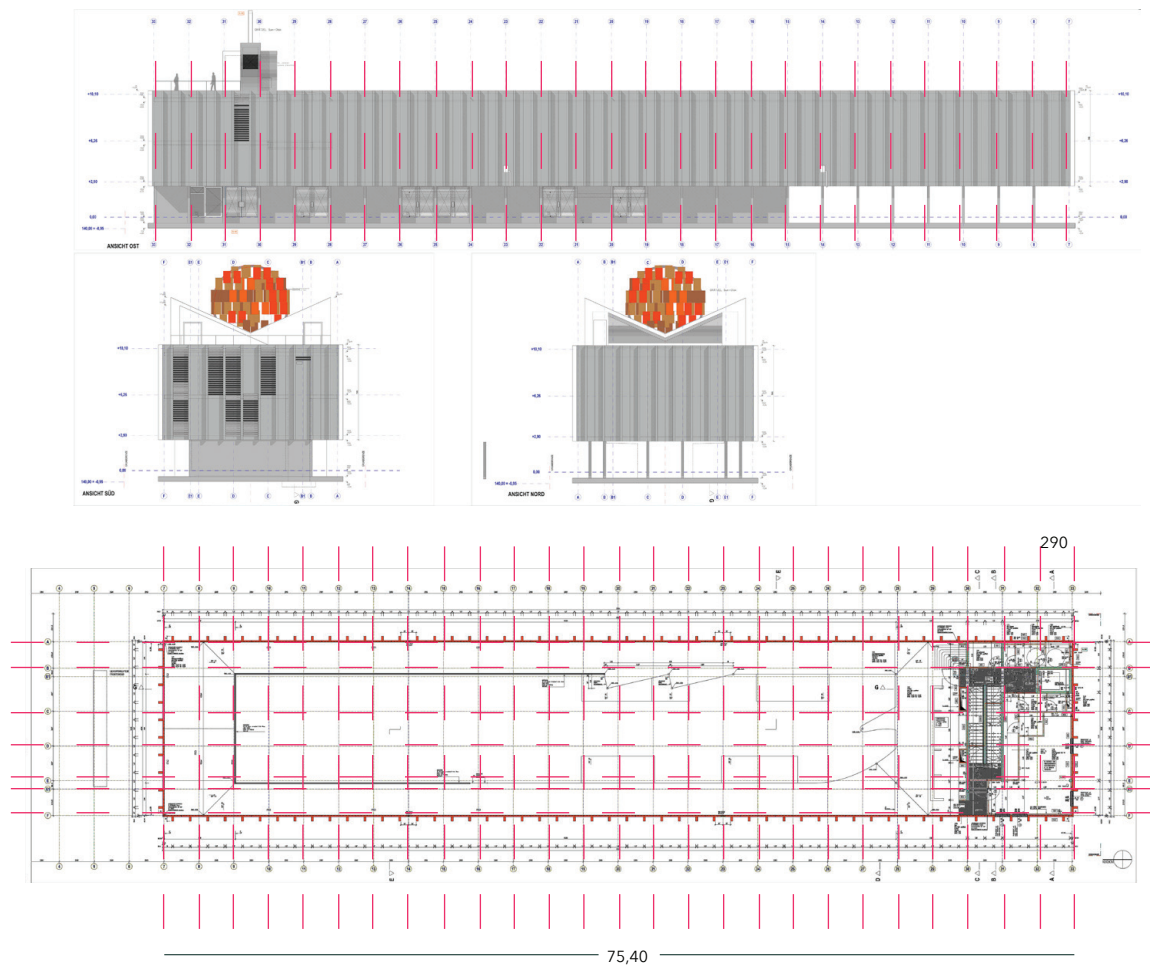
Planta e corte demarcando a modulação da estrutura e dos painéis. Desenhos da autora sobre originais
